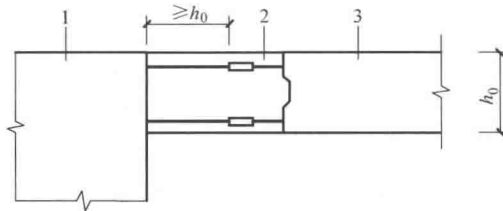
连梁纵向钢筋在后浇梁段内连接示意
